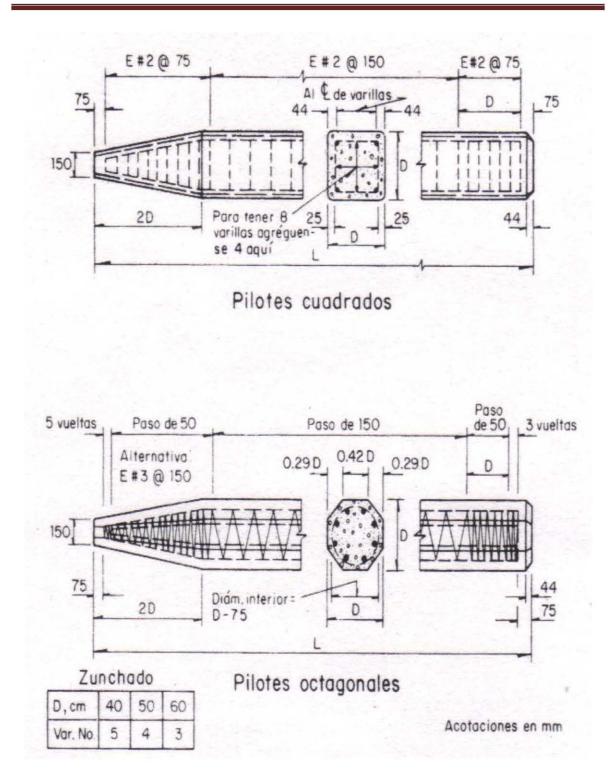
Detalles típicos de pilotes de concreto precolados
